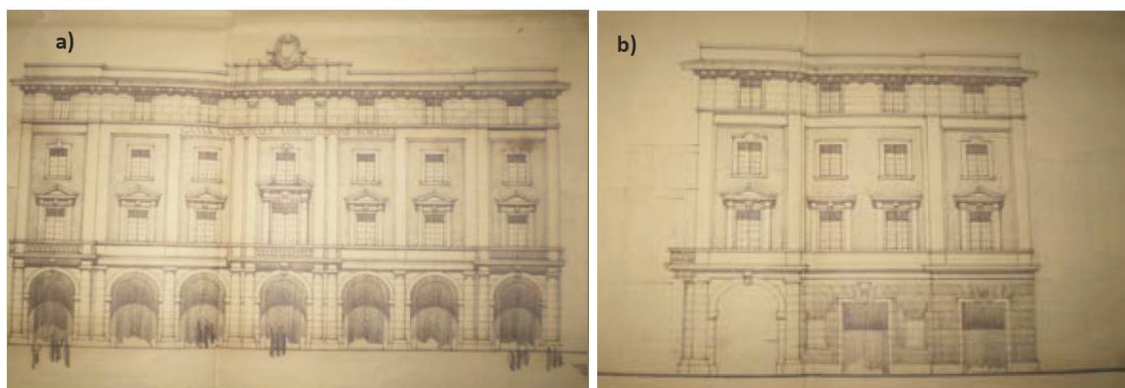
Progetto originale: a) prospetto frontale, b) prospetto laterale.
